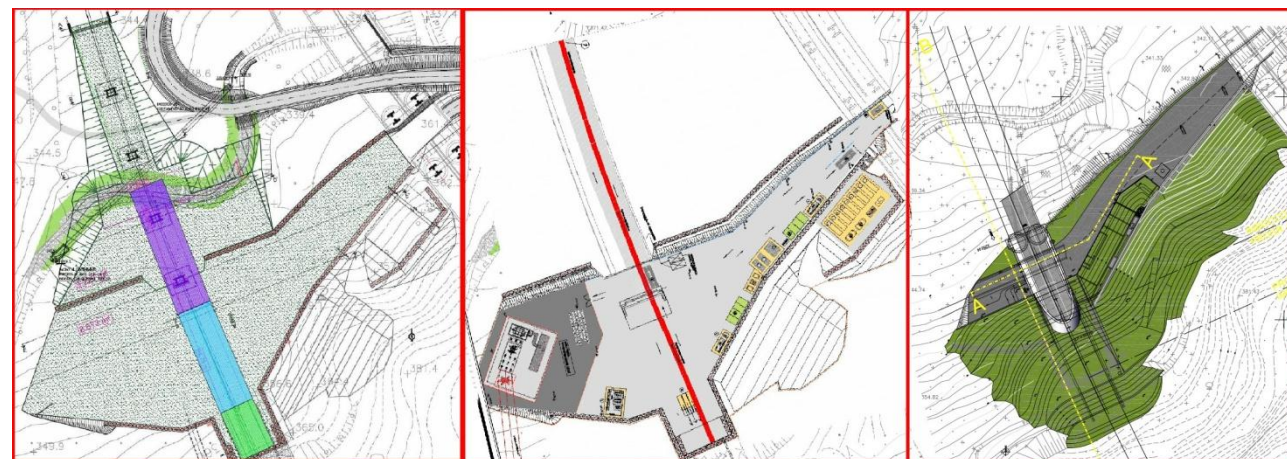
evoluzione del progetto del cantiere CA08: Proposta attuale (Sx) – Progetto approvato con la Variante S. Lucia (Centro) e progetto iniziale (Dx)
